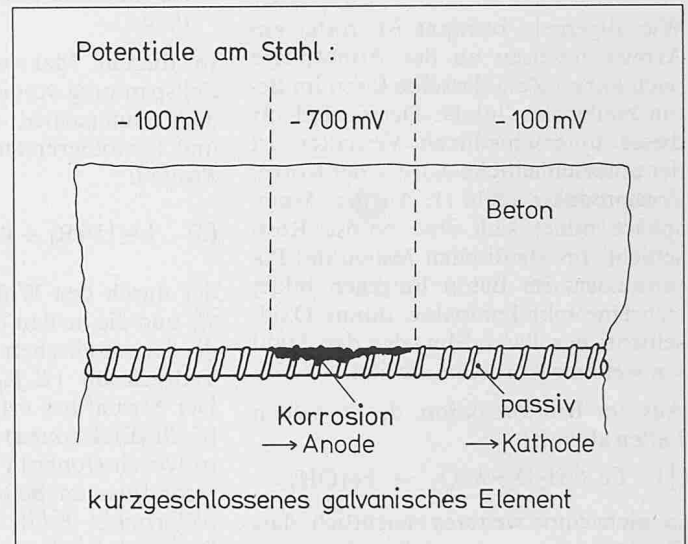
Nebeneinander von korrodierenden und intakten Bereichen des Armierungsstahls in Beton (schematisch)
